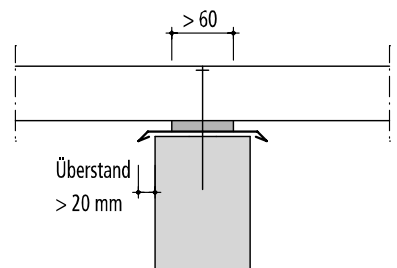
Abdeckung mit Blech bei einem schmalen Träger, ohne Belüftung z.B. für Geh- und Radwegbrücken
